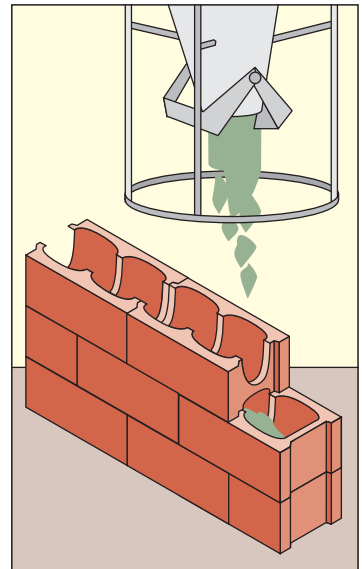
Mauerwerk mit Vermörtelung durch Gießmörtel
